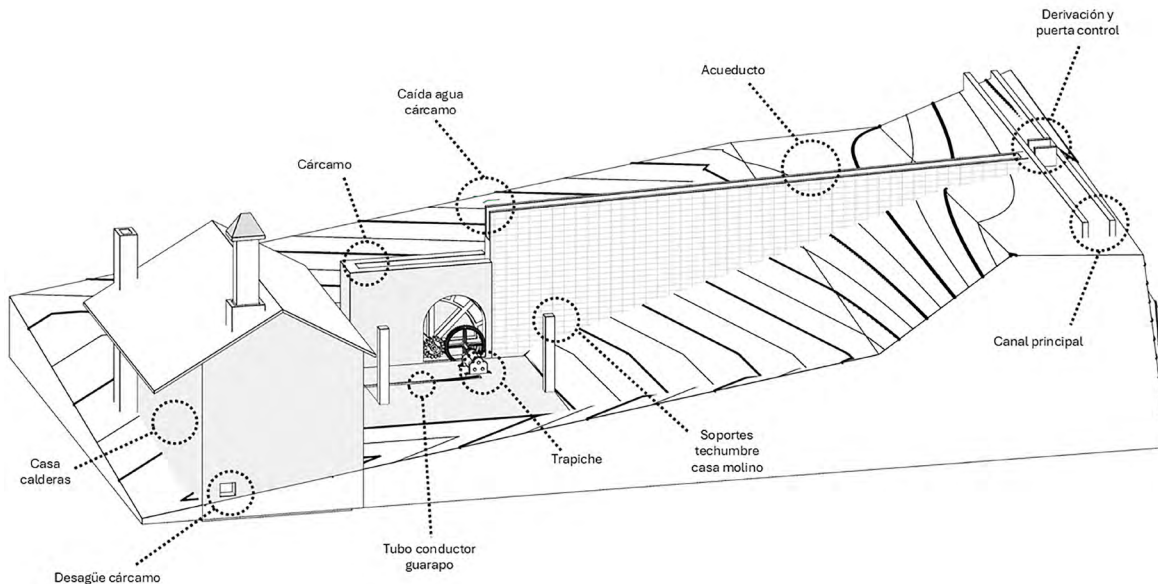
Reconstrucción hipotética funcionamiento infraestructura hidráulica trapiche piloncillero Etucuarillo. Fuente: elaboración propia con base en: CONAGUA-AHA, FAN, Caja.985, Exp.12644, Leg. 1, f.49.
